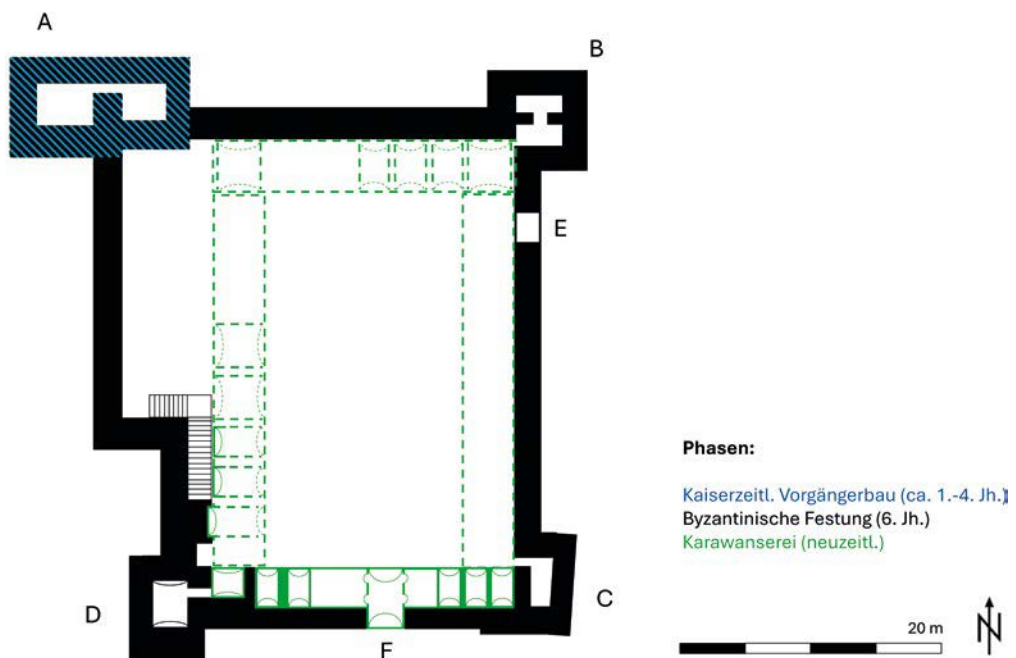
Agbia. Grundriss der Festung mit Phasenplan (P. Margreiter)
